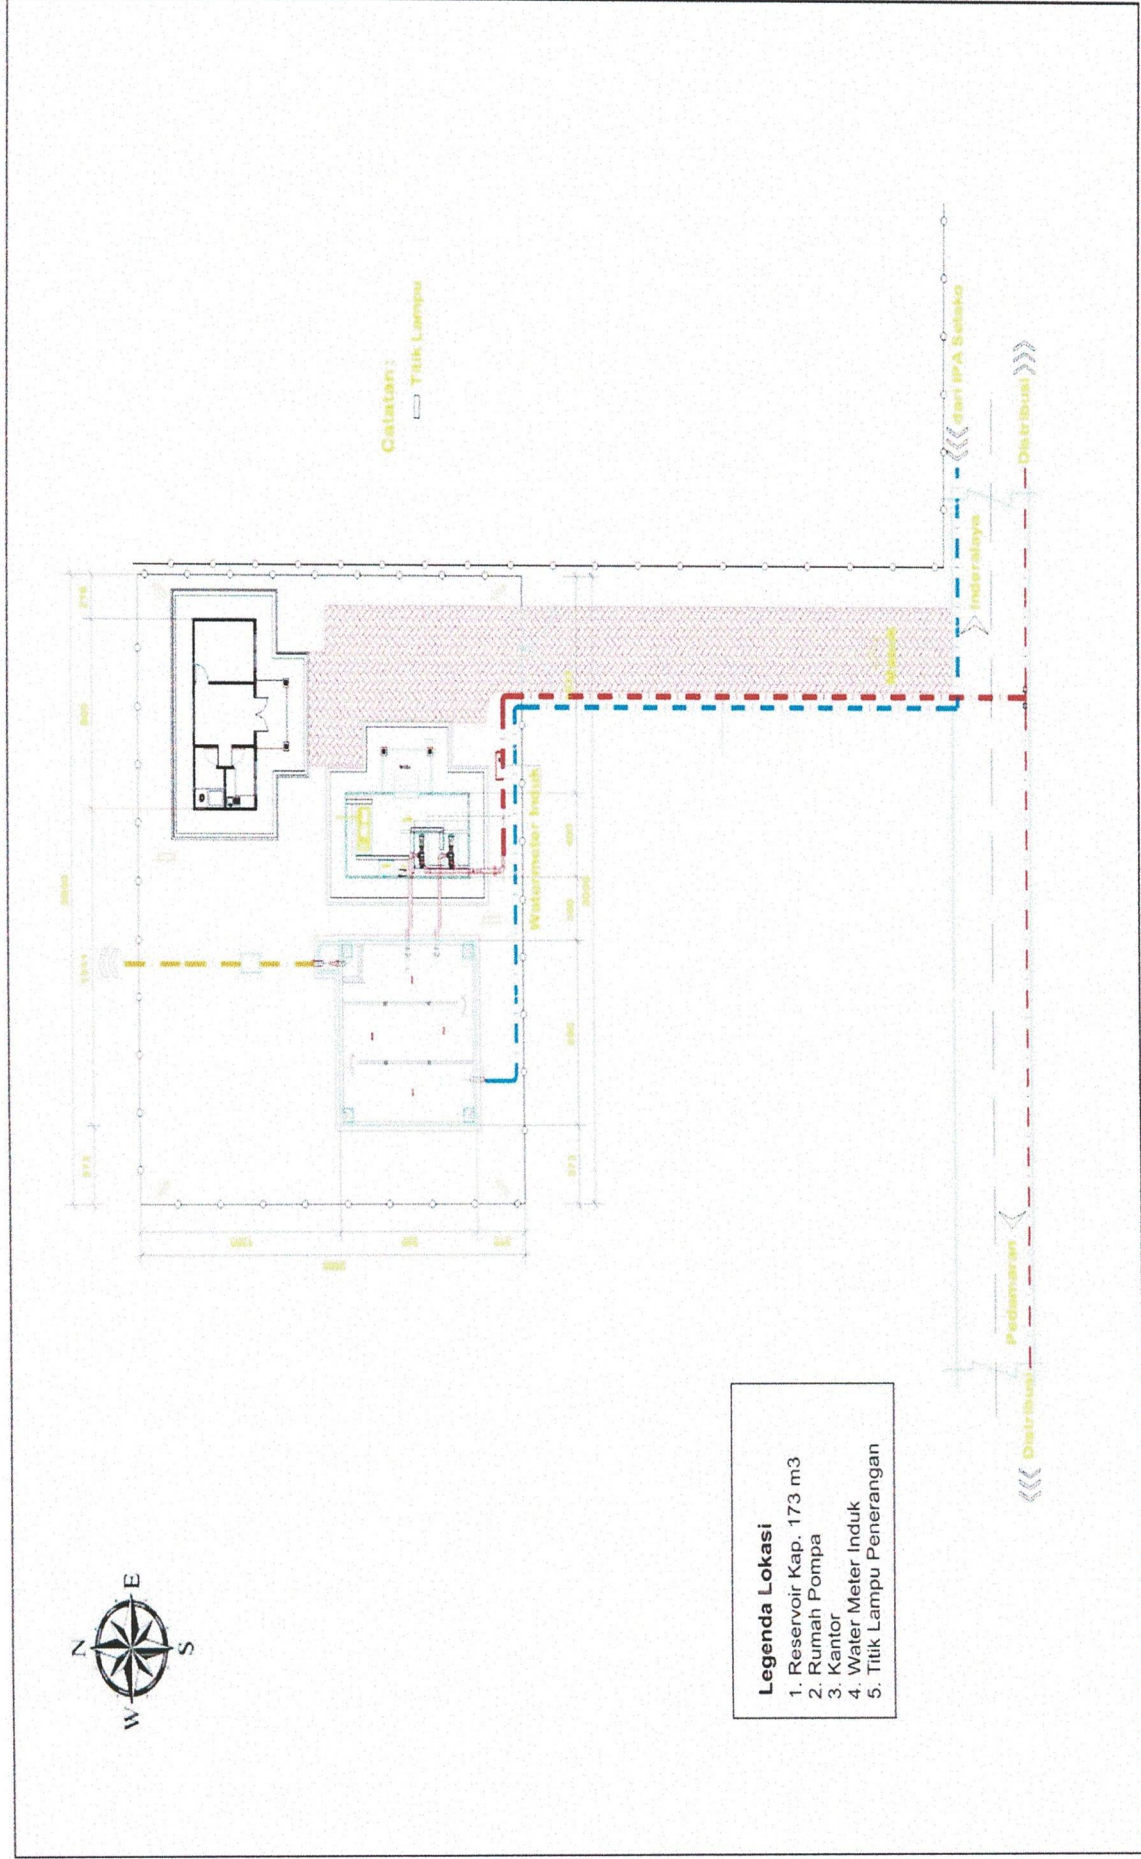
Site Plan IPA Tanjung Senai Kapasitas 40 liter/detik
